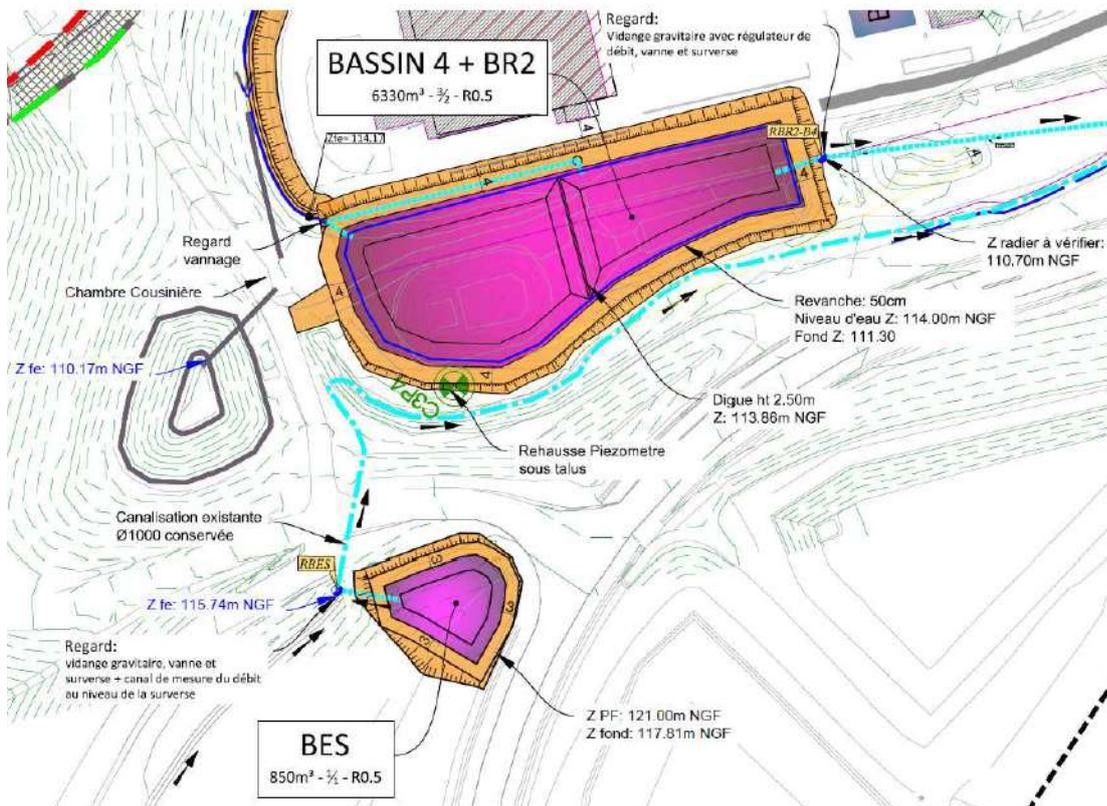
aménagement de la zone 2 – Extrait du plan 2
